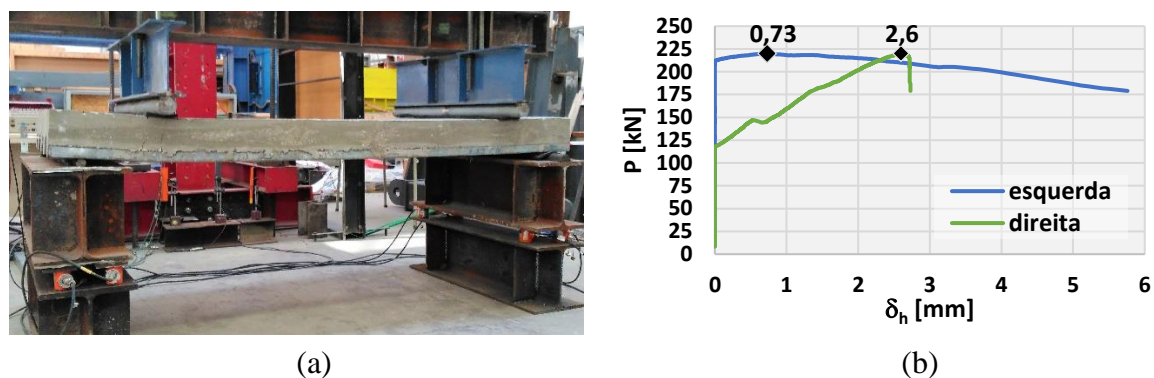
(a) Aspetto final do provete E.1 (b) Deslocamento relativo (chapa-betão)
